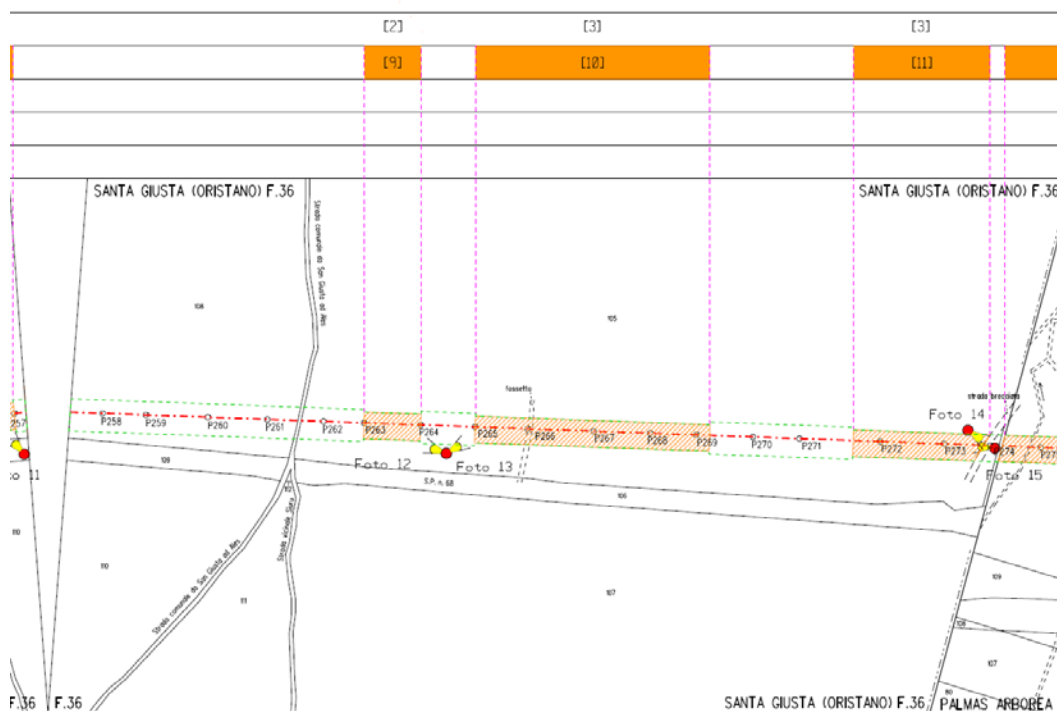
Tratto P265 – P269+10mt - la zona delimitata dalle linee verdi rappresenta la fascia ristretta di lavoro per come previsto dalla GASD C 13.40.10.02
